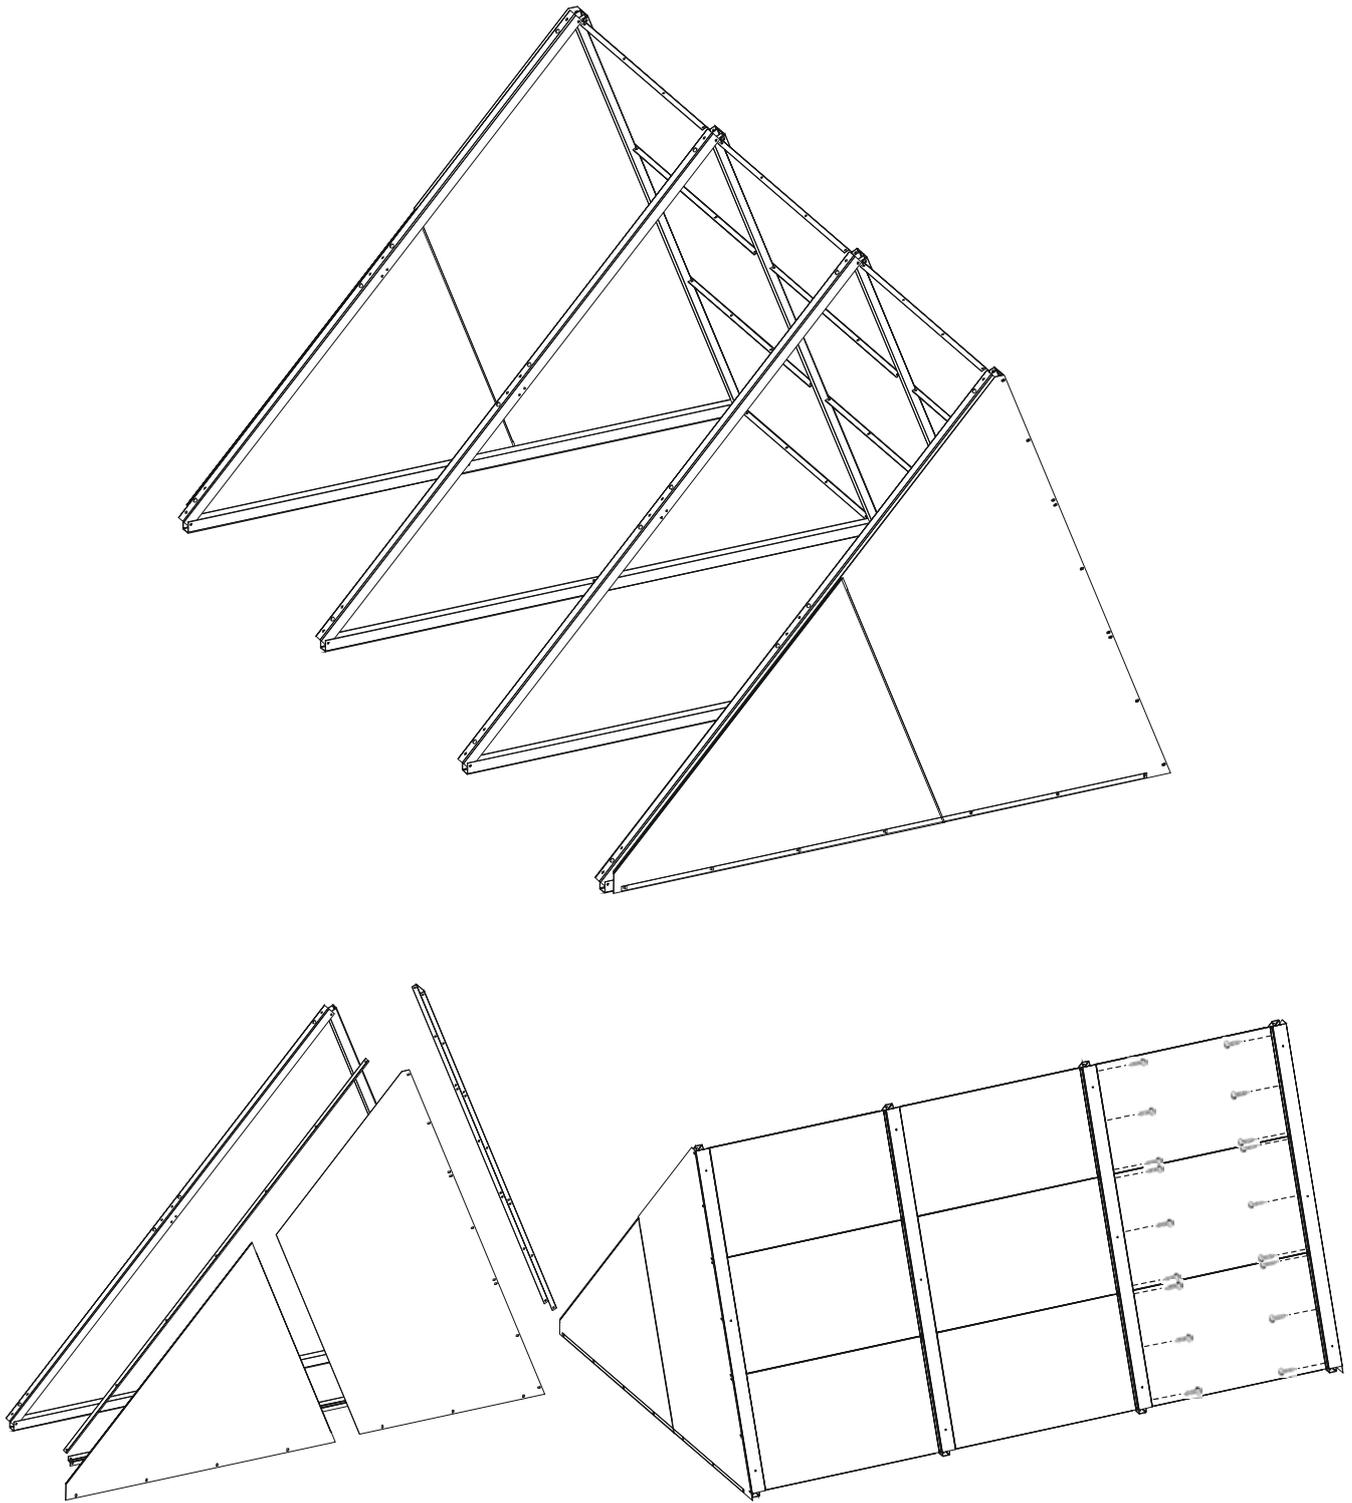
Exemples de supports toiture-terrasse avec capots cache-support.
